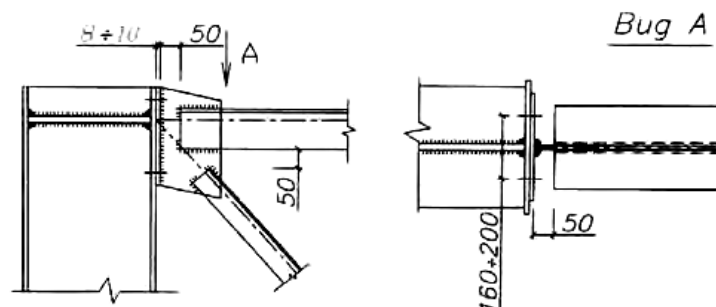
Крепление фермы к колонне в уровне верхнего пояса
